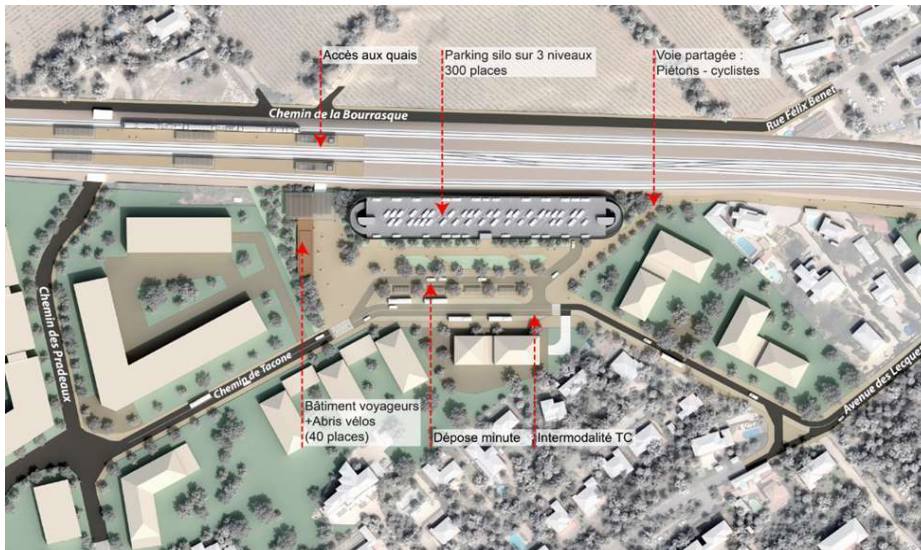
Spatialisation du PEM de Saint-Cyr-sur-Mer – Plan de masse (AREP, 2021)
